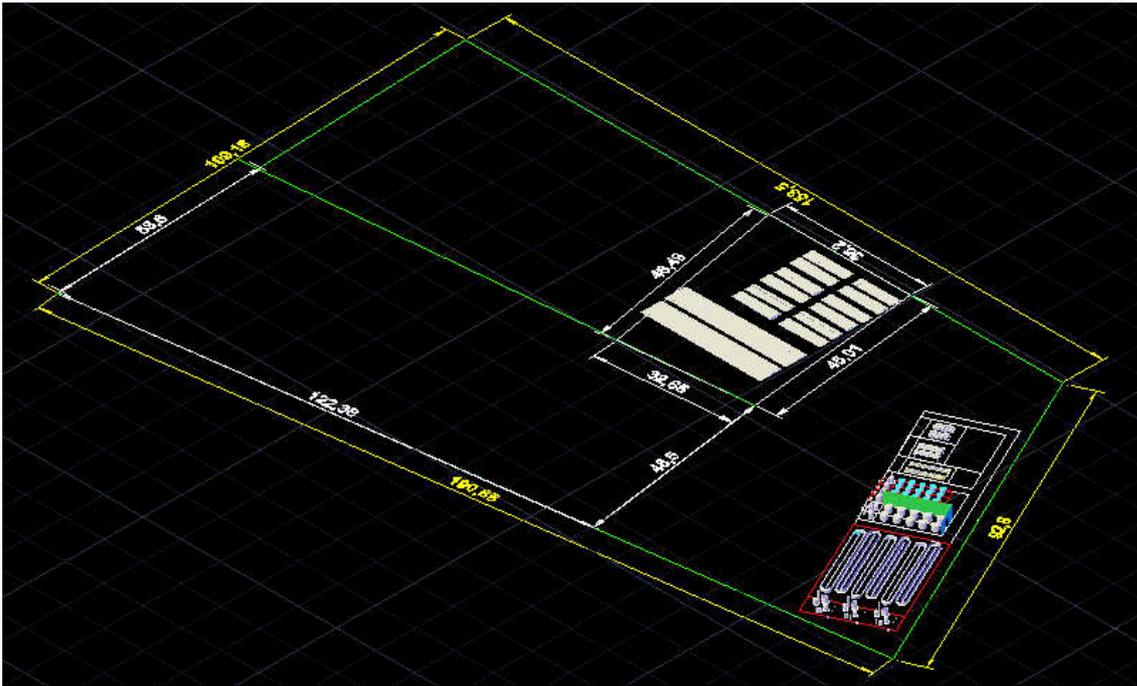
Esquema con la ubicación del invernadero respecto a los terrenos elegidos para la construcción de la planta de producción. Los rectángulos blancos que se observan en la parte central hacen referencia a los tanques de hormigón que ya hay construidos en una de las parcelas.
